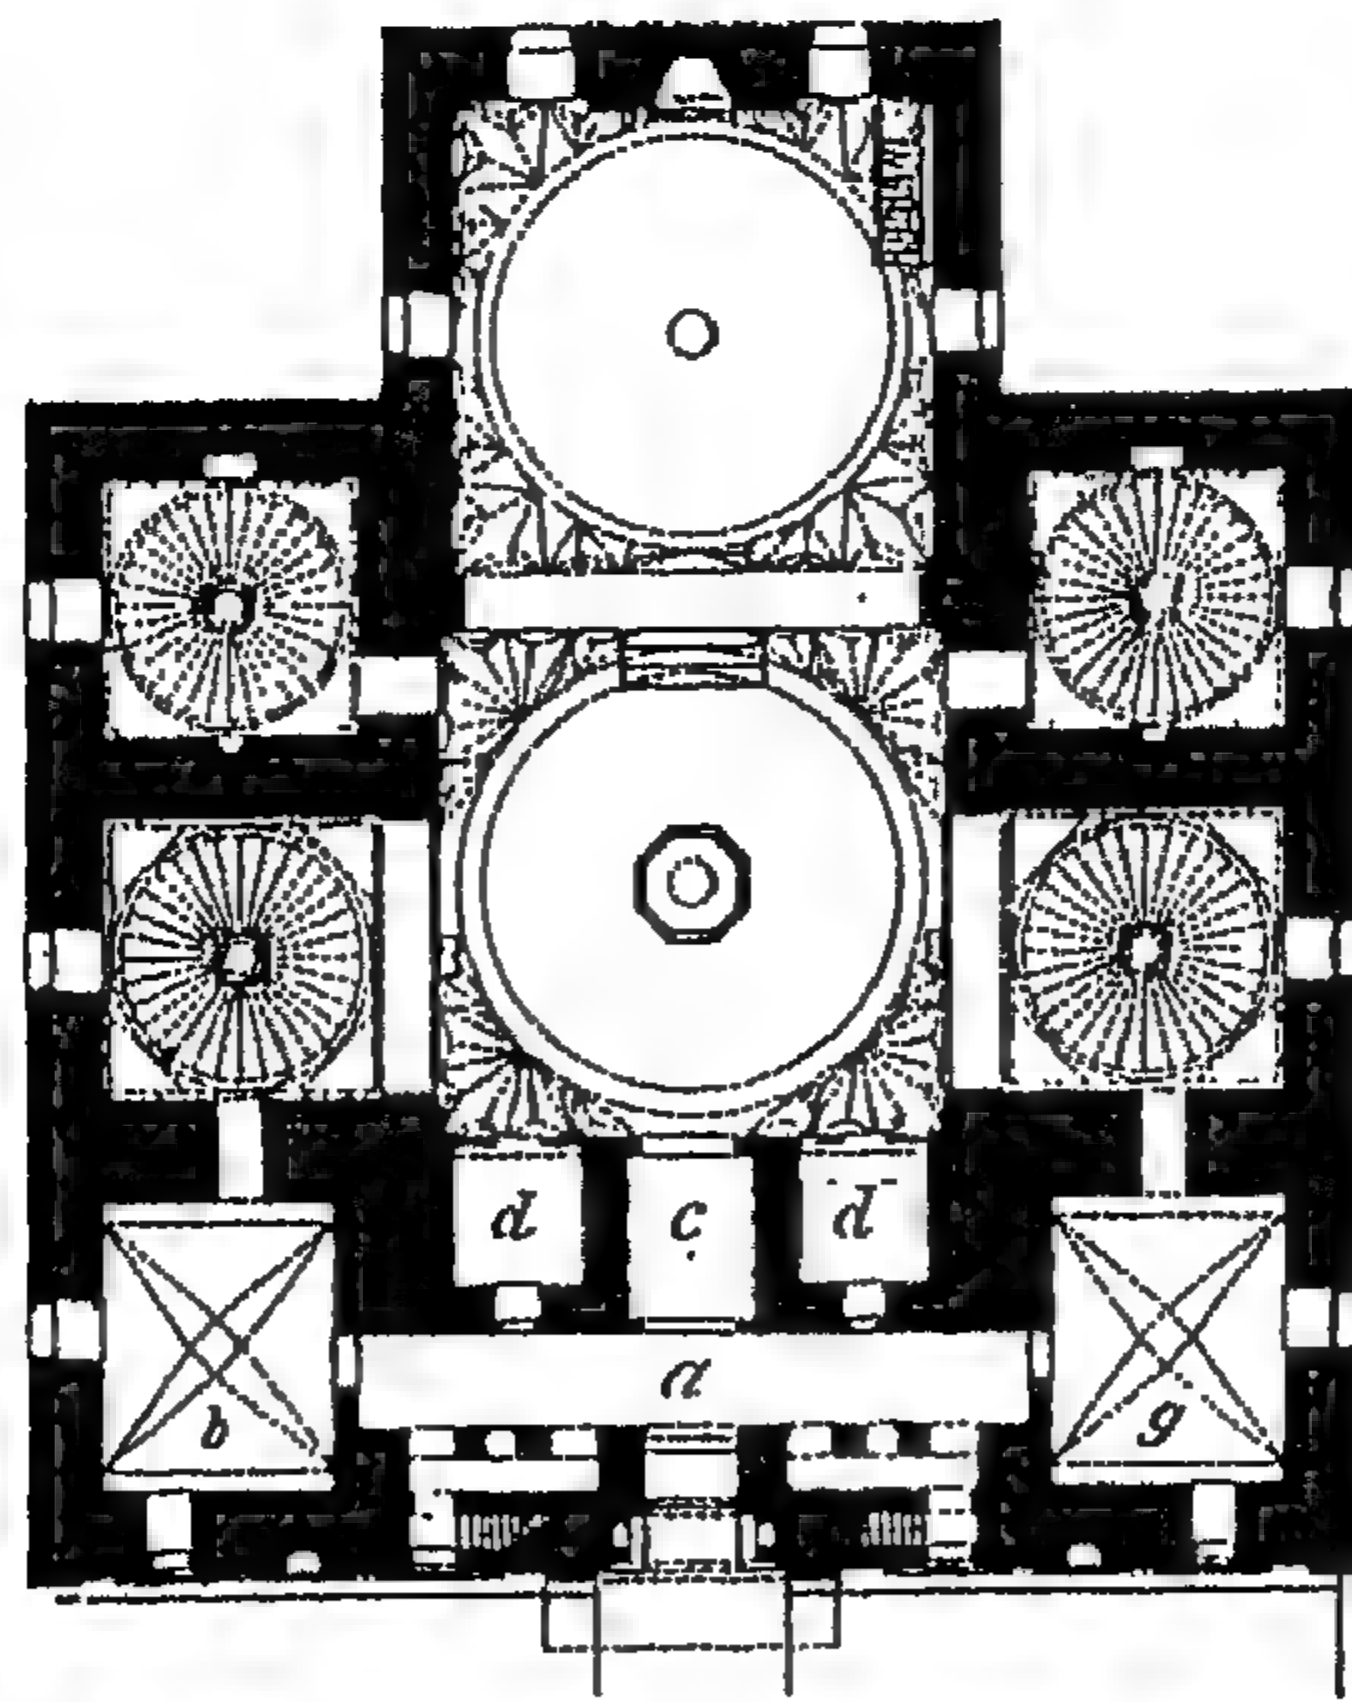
مسقط أفقي لجامع السلطان أحمد الاول باستانبول (عن : Goodwin) .
